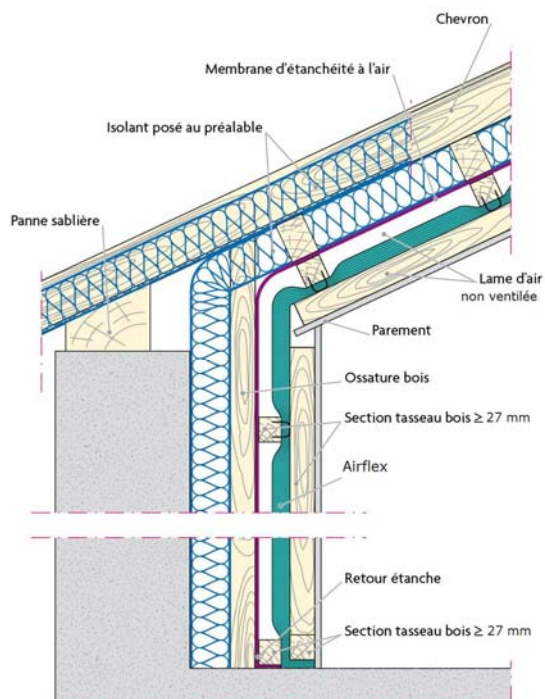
Pose sans écran sous-toiture avec membrane d'étanchéité de la lame d'air
